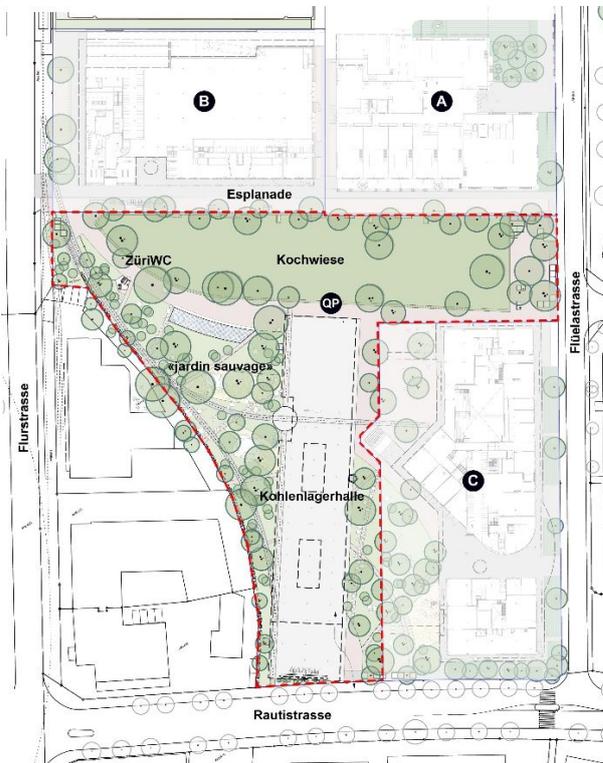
Übersichtsplan Quartierpark mit Kohlenlagerhalle
